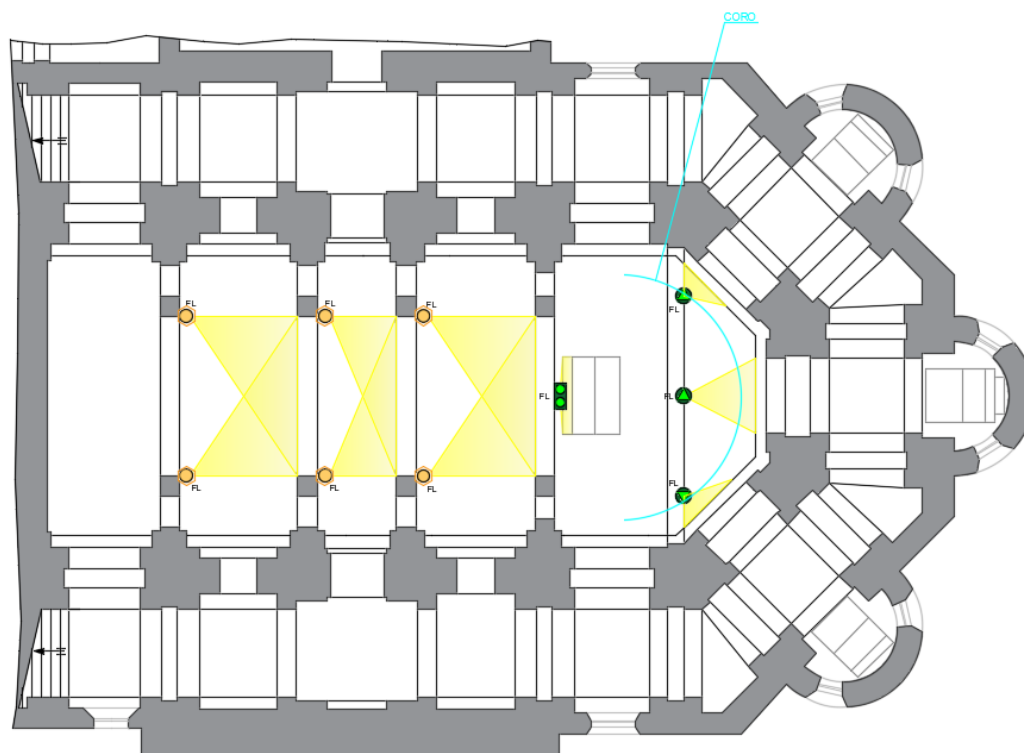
pianta dei fasci di luce rivolti verso il pavimento
